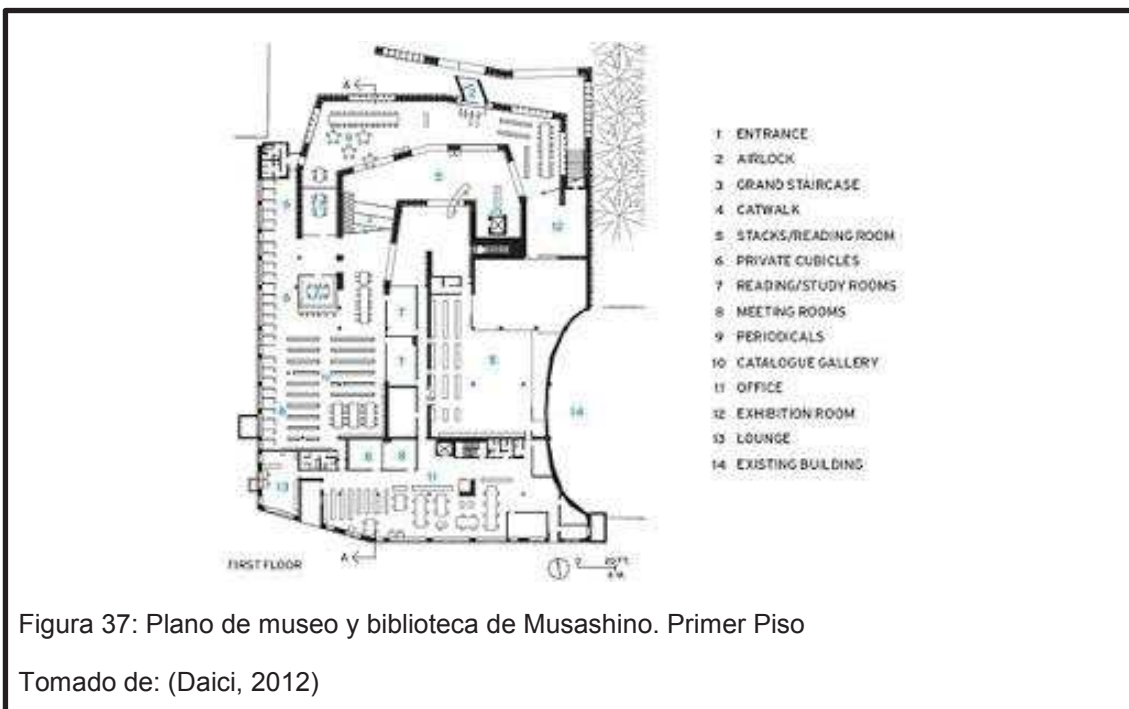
Plano de museo y biblioteca de Musashino. Primer Piso
